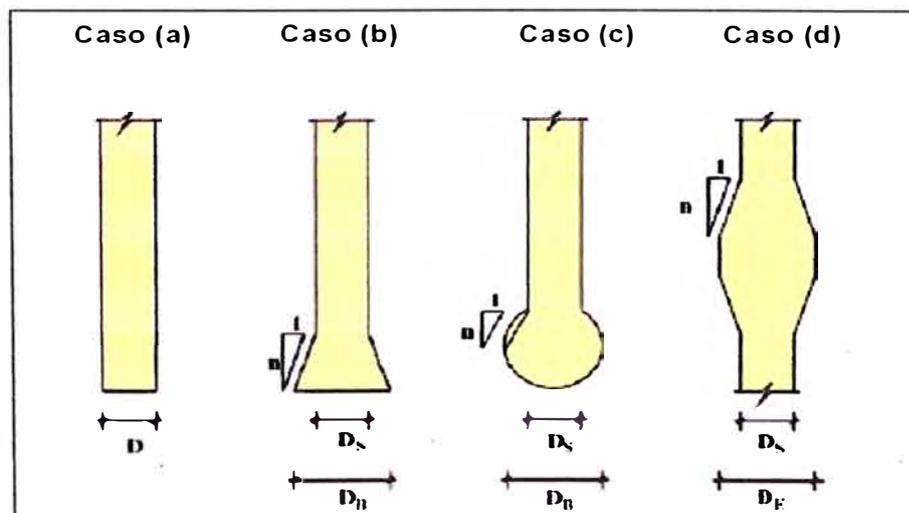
Tipos de ensanche de pilotes según su ámbito de aplicación.
